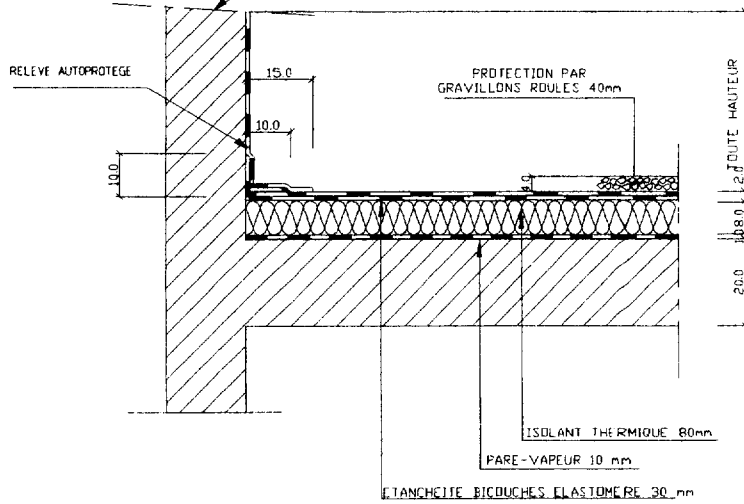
DETAIL TYPE SUR RELEVÉ DES T.T. ET DE LA TERRASSE INACCESSIBLE DU NIVEAU 5
